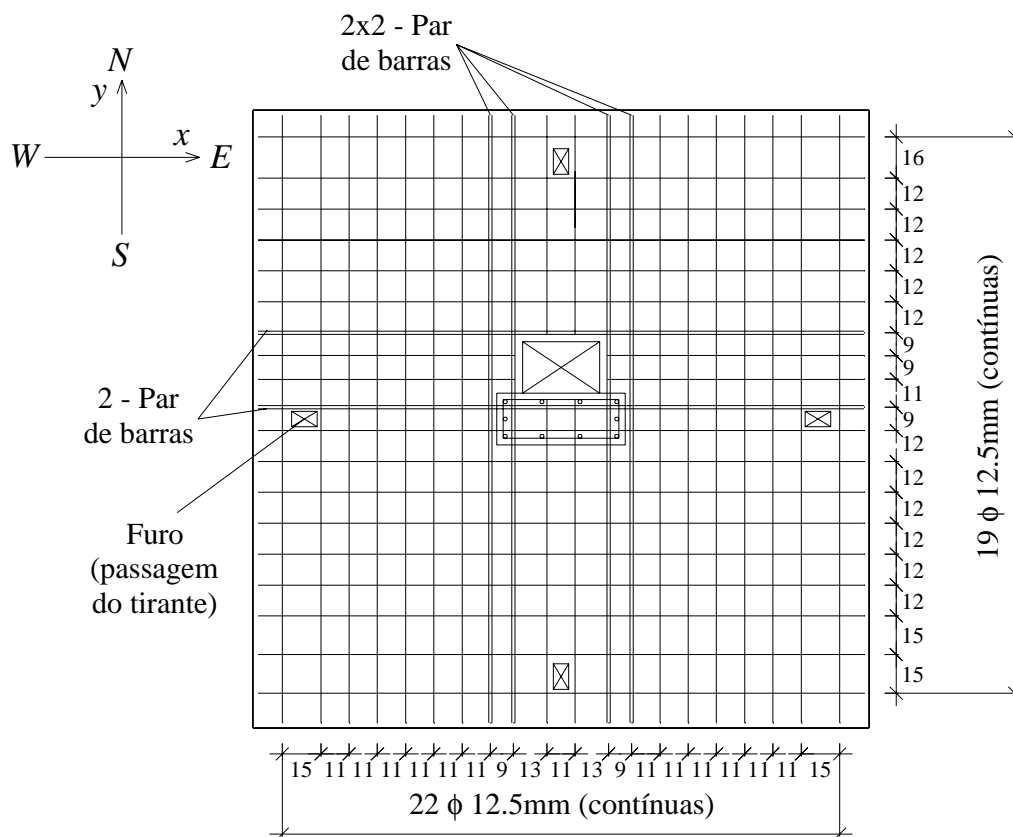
Armadura de flexão das lajes L16 e L17 (cm)
